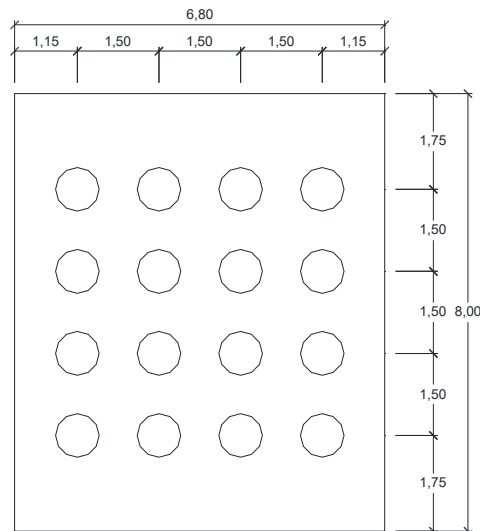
Sketsa penulangan tiang pancang *abutment
